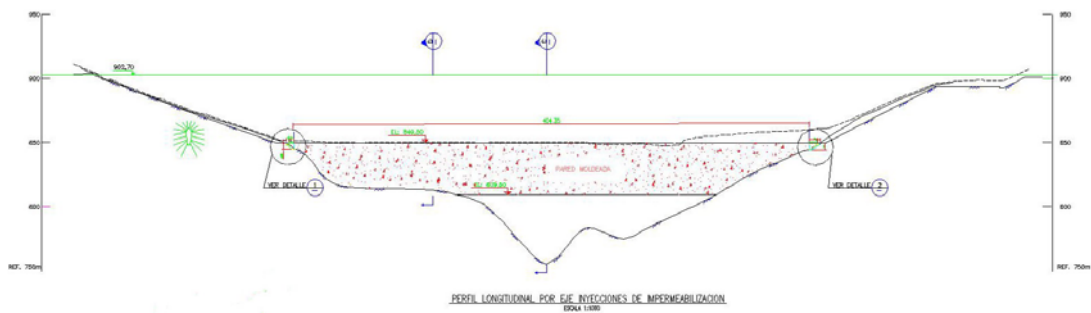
Perfil por el eje de la pantalla de impermeabilización del aluvial
